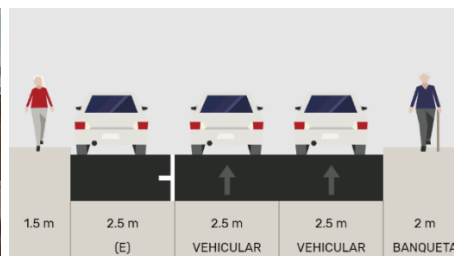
Vialidad y sección vial de la C. Río Aros. Fuente PDU 2040 vigente.
